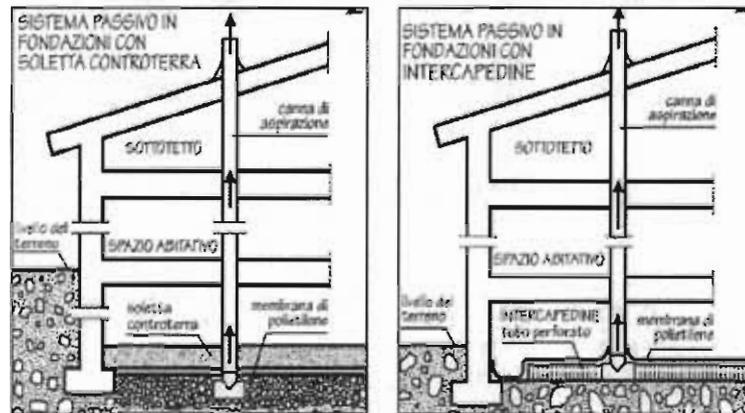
Sistema passivo in fondazioni con soletta controterra; Fig. 2 – Sistema passivo in fondazione con intercapedine.
